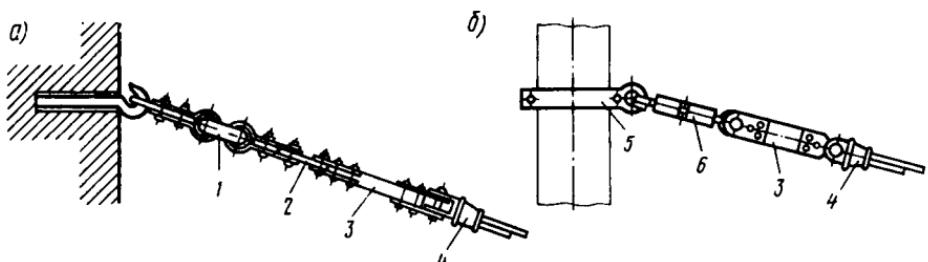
Схема закрепления гибких поперечин: на стене (а), на опоре (б):
